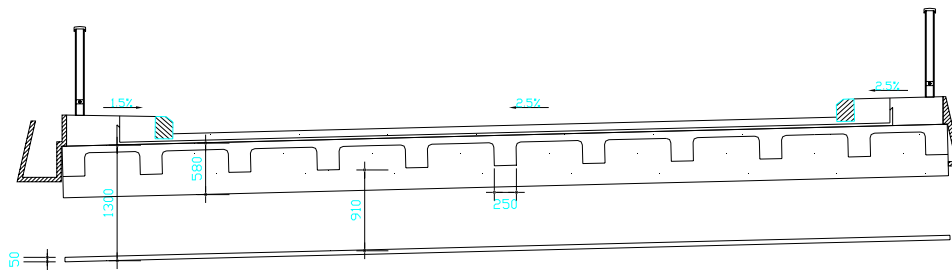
Coupe transversale - solution 25 m - Dalle BFUP gaufree-échancrée et matériau composite
